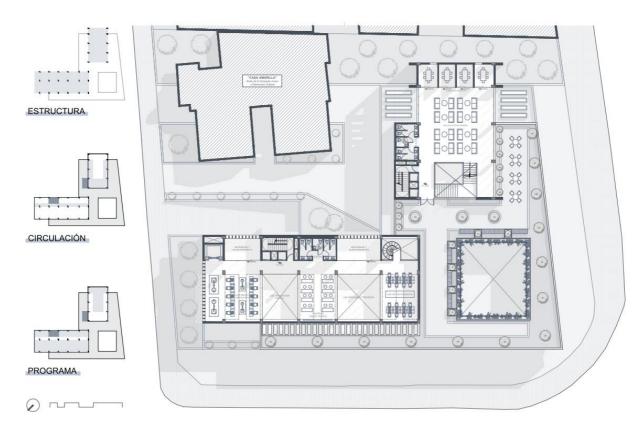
Planimetría: Planta Alta 2 (N+8,00)
